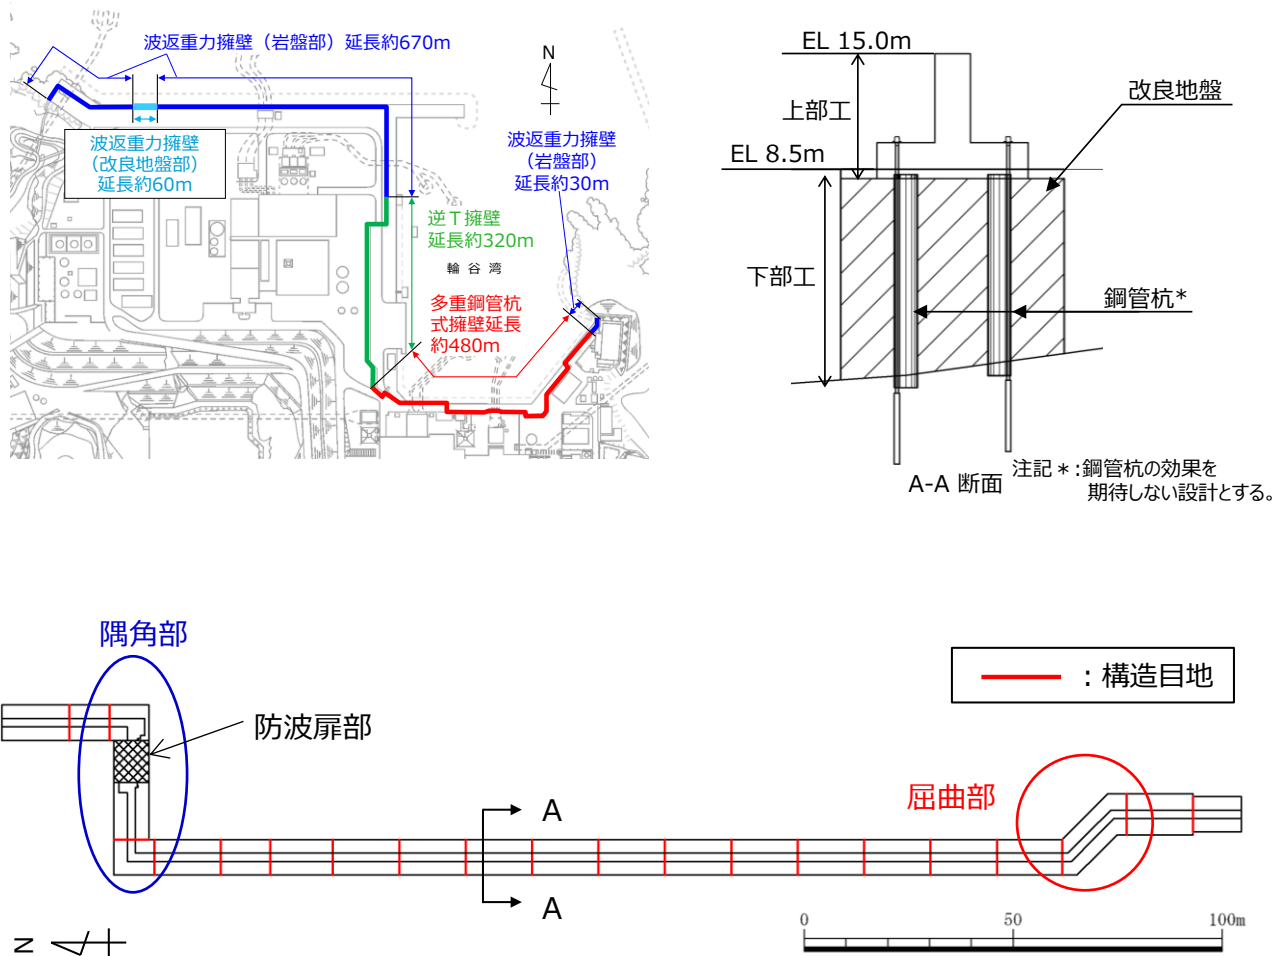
防波壁（逆T擁壁）の構造目地（平面図）
